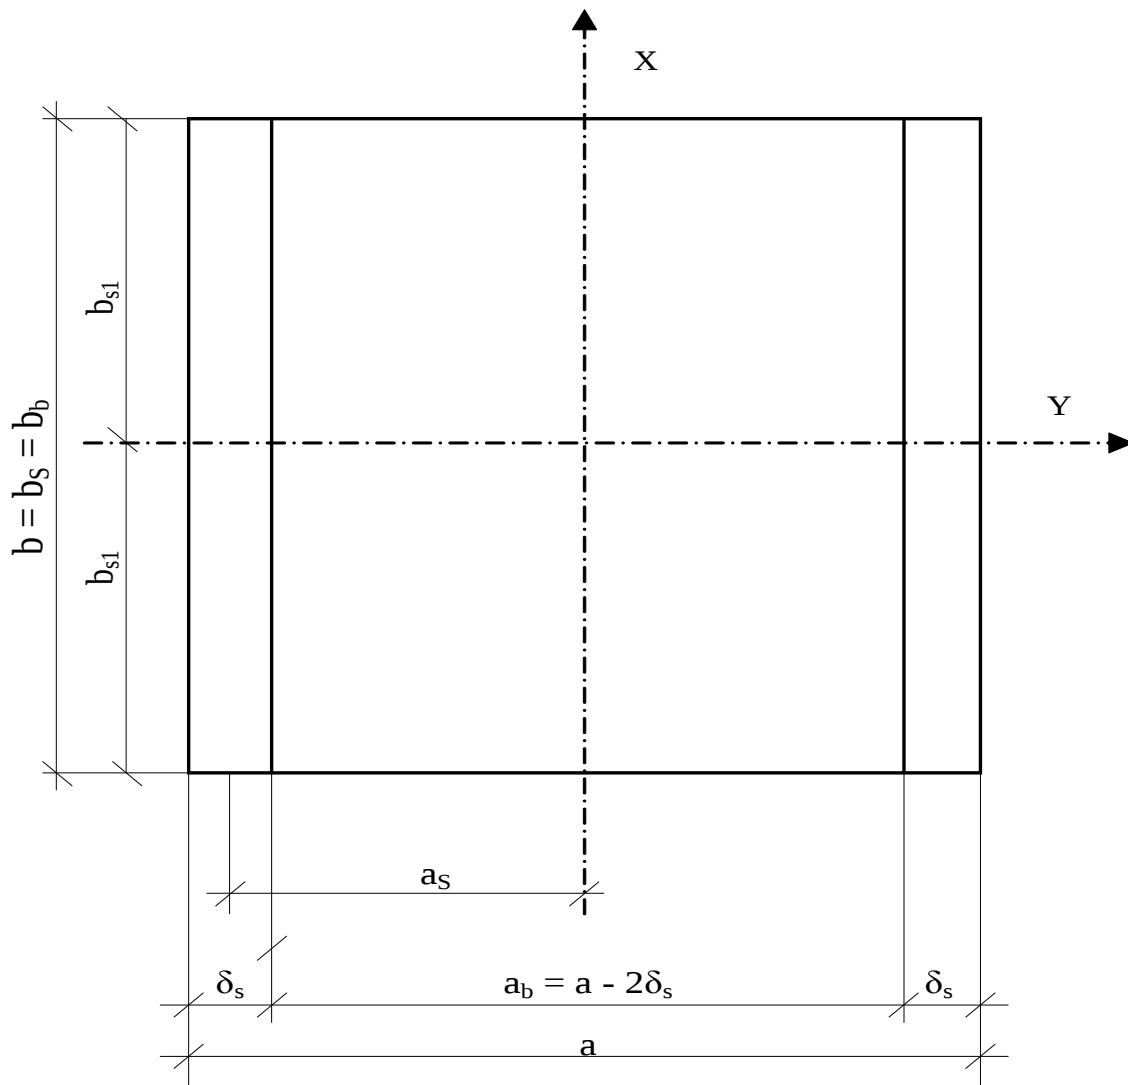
Поперечний переріз сталобетонного елемента з листовим армуванням за розрахунком при розрахунку за зведеним до сталі перерізом
